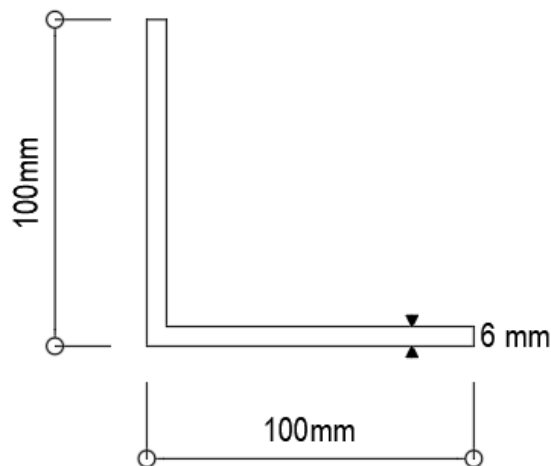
Corte transversal de los elementos del diafragma variante vigas de acero.
